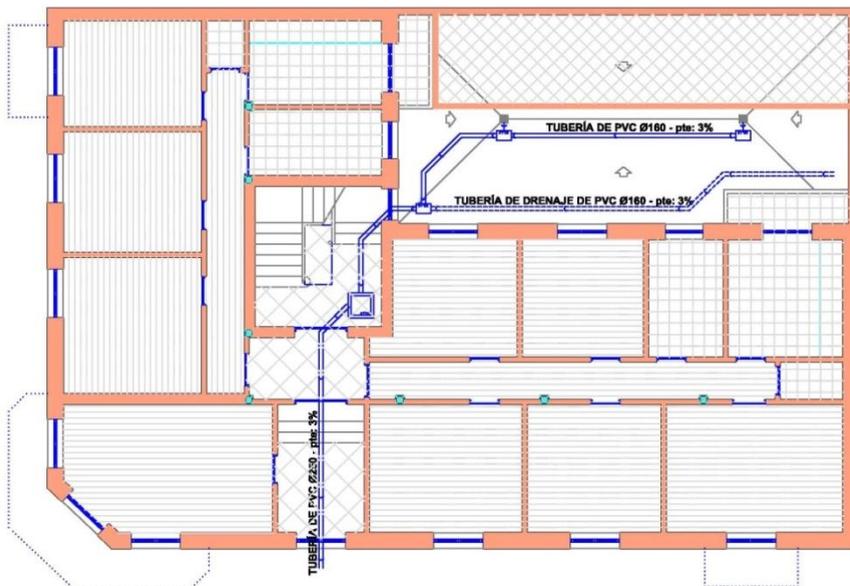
Solera y drenaje en planta baja. Año 2015. Fuente: elaboración propia.
